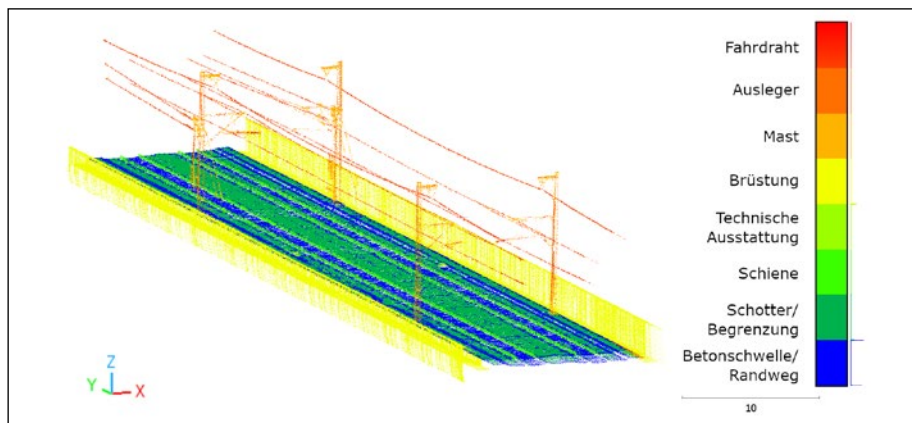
Klassifizierte Bauwerkselemente einer Eisenbahnbrücke
